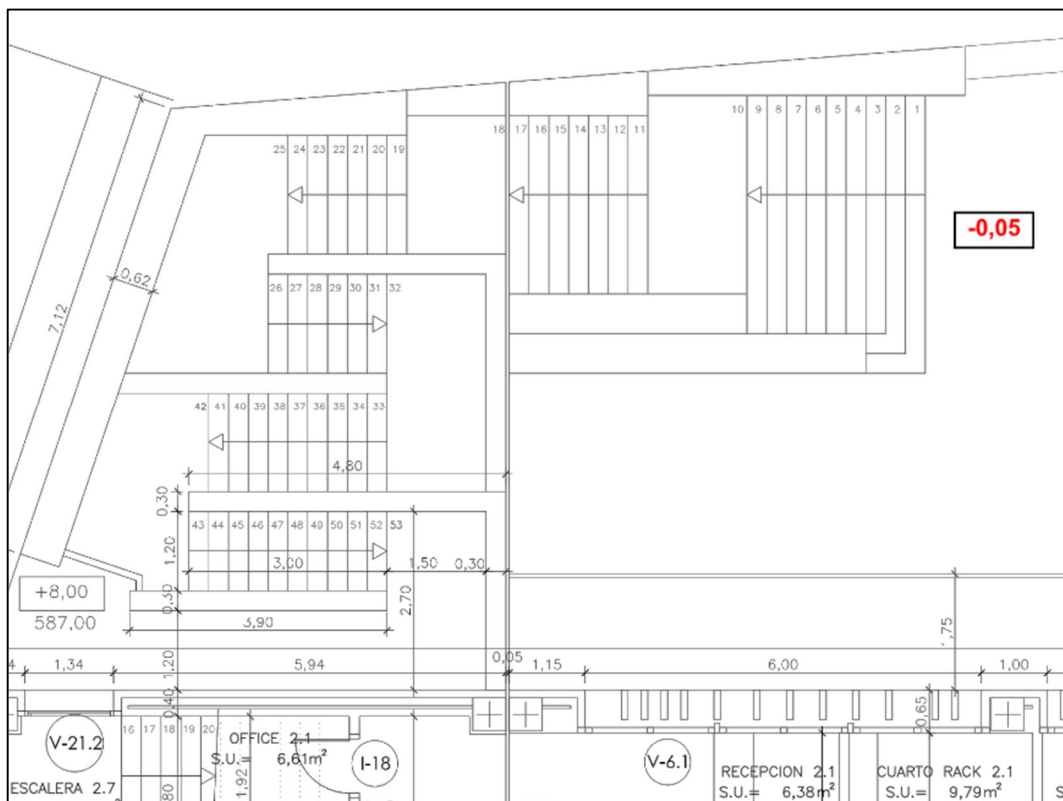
Escalera exterior 3. Planos de Replanteo
